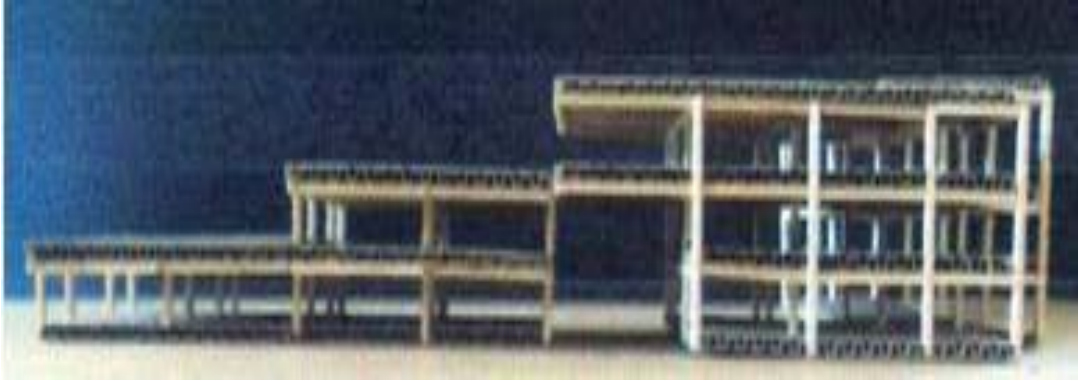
Alzado estructural del conjunto principal formado por el edificio A y B.
